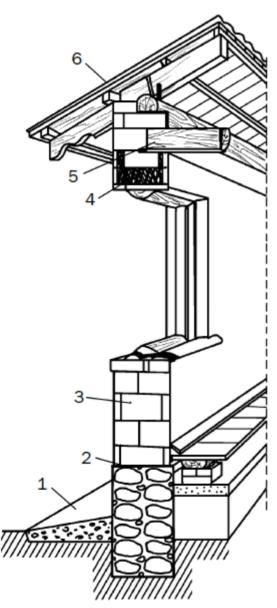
Конструкция стены из легкобетонных блоков: 1 – отмостка; 2 – слой гидроизоляции; 3 – кладка; 4 – перемычка; 5 – изоляция балки перекрытия; 6 – кровля
